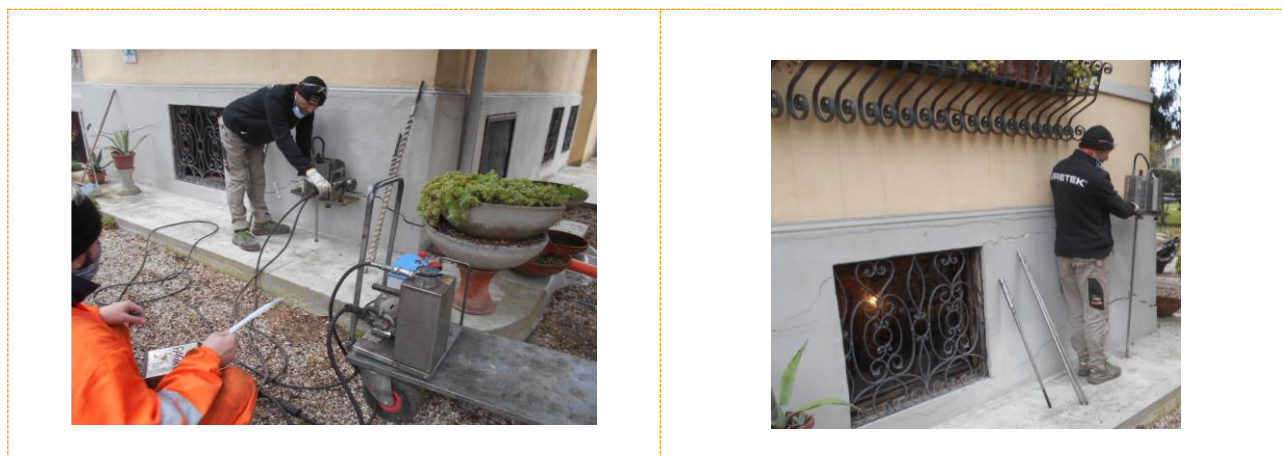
Esempio di trattamento con URETEK MULTIPONT® : FOTO prove penetrometriche
